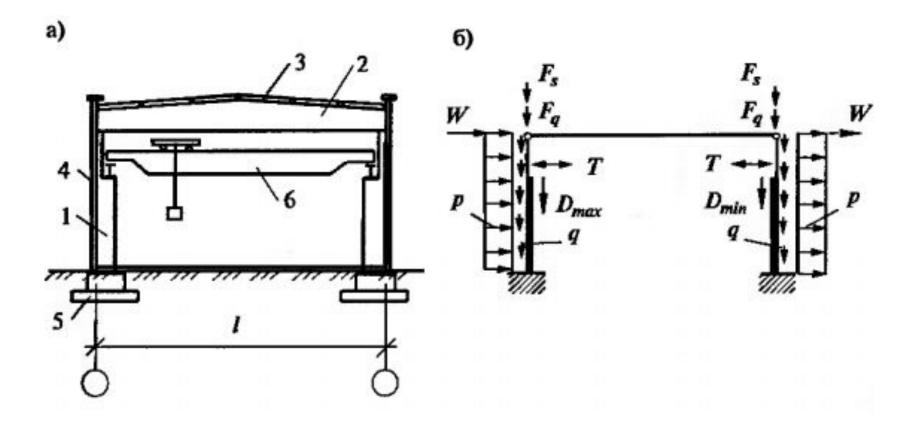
Поперечная рама одноэтажного производственного здания: а) конструктивная схема; б) расчетная схема рамы; 1 — колонны; 2 — стропильная балка; 3 — плита покрытия; 4 — стеновая панель; 5 — фундамент; 6 — мостовой кран с крановой тележкой
